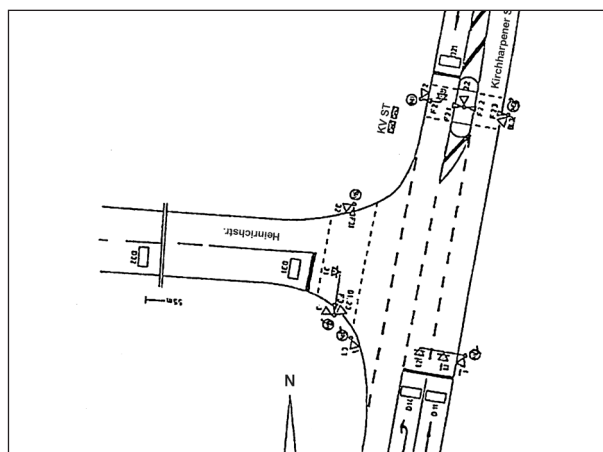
Signallageplan des Knotenpunkts Heinrichstraße/ Kirchharpener Straße in Bochum
